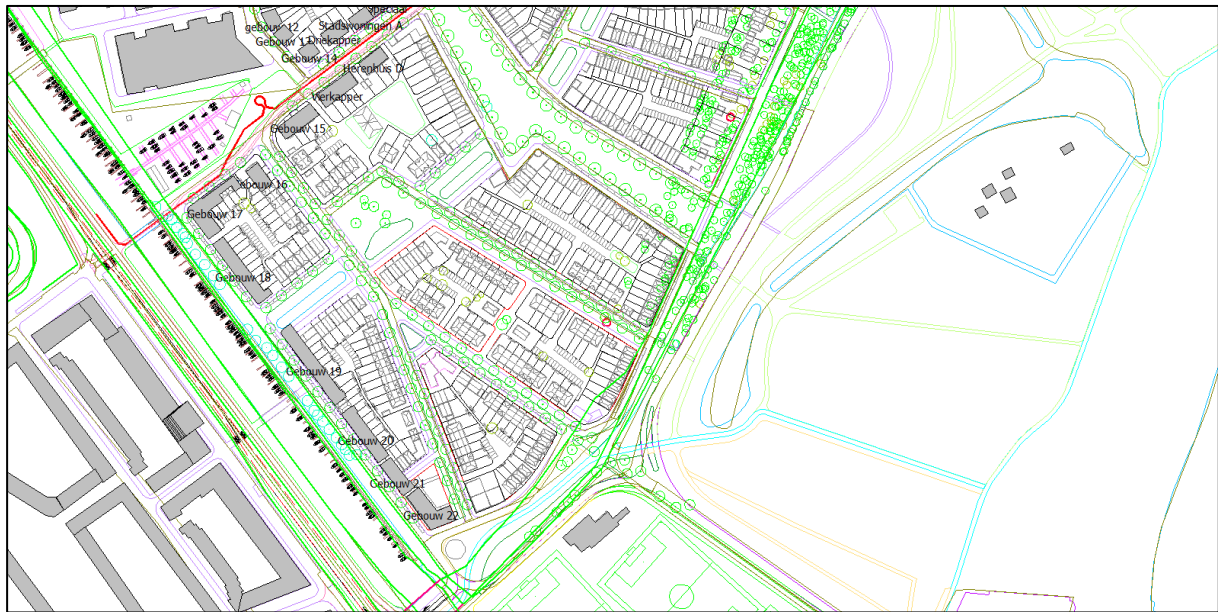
stedenbouwkundig verkavelingsplan met eerste bebouwingslijn.
